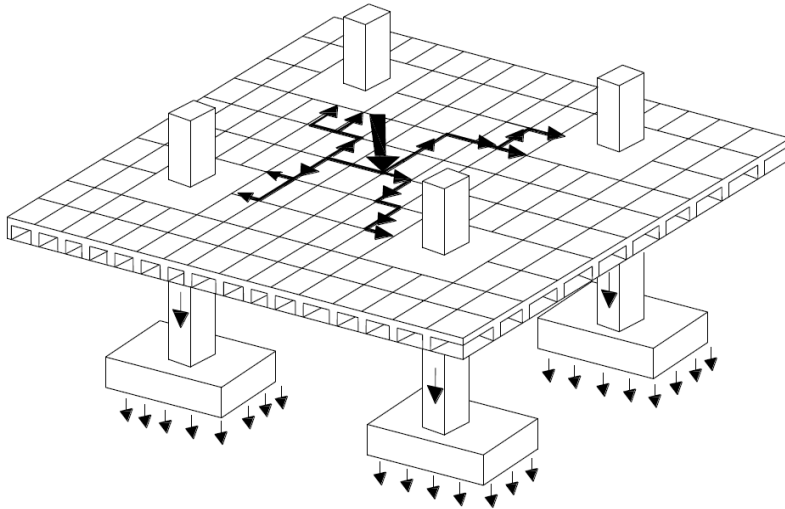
Modelo icônico de uma laje aligeirada (fonte - Trindade 2009)
